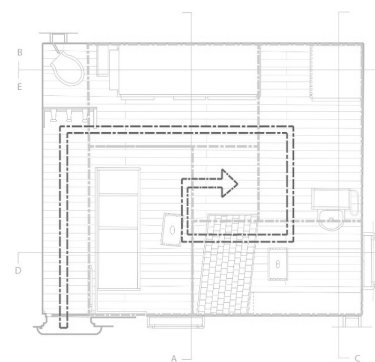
Proporção áurea aplicada na planta do *Le Cabanon
